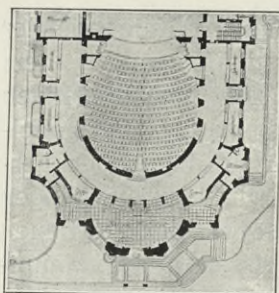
Neues Königliches Theater zu Bad Kissingen. Grundriß des Zuschauerhauses im Erdgeschoß.
